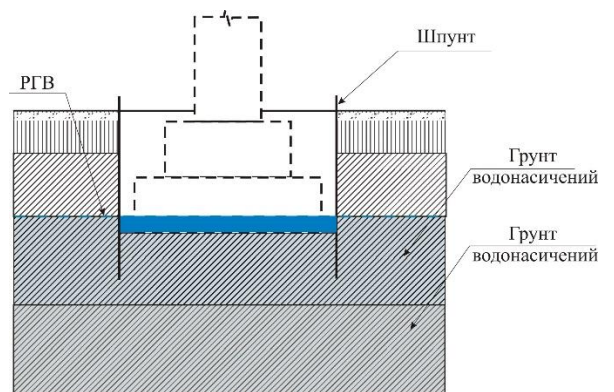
Схема котловану з рівнем ґрунтових вод вище дна котловану та забитим шпунтом до водоупору
